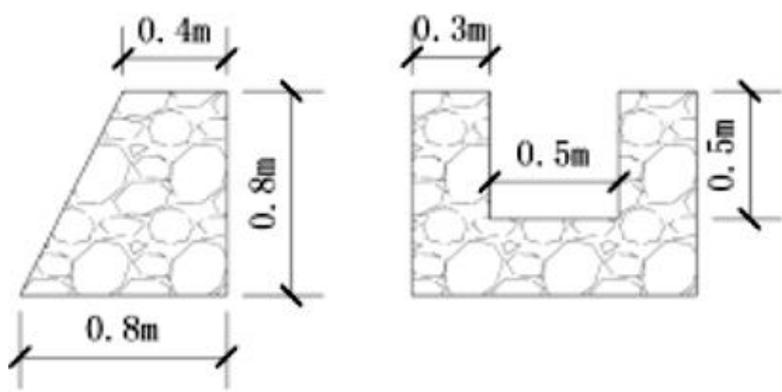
植生槽外侧挡墙及内侧排水沟剖面图
